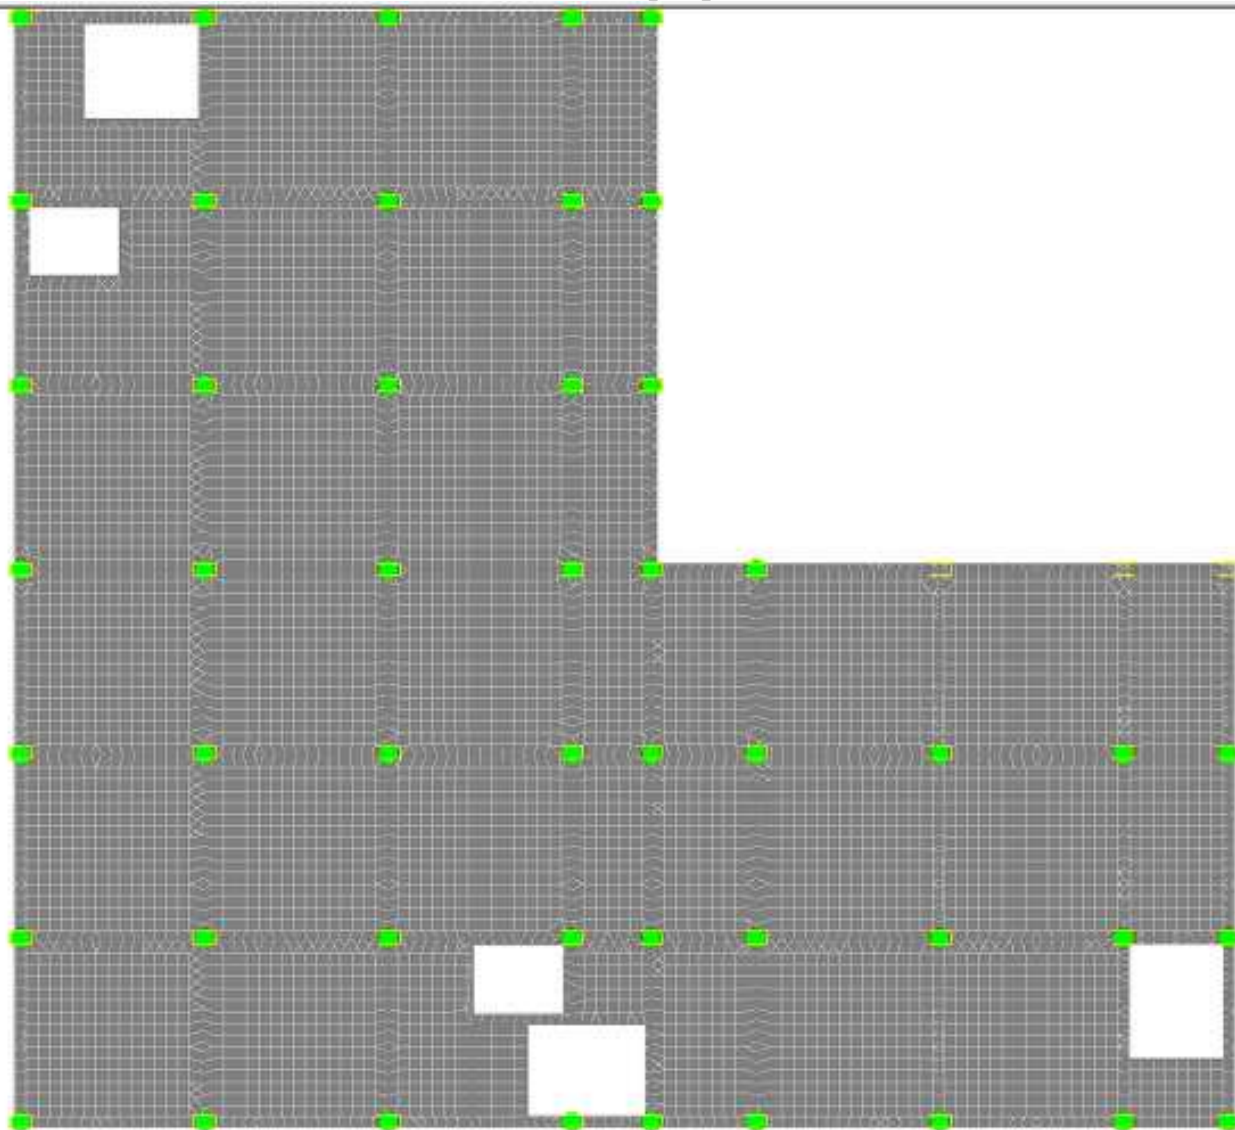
Расчетная схема монолитной плиты перекрытия.
